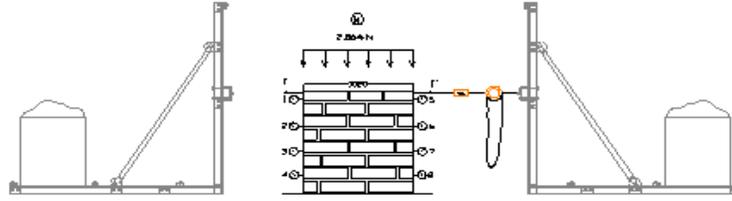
Esquema de ensaio da parede, no plano: pórticos de reacção, transdutores de deslocamento, dinamómetro e sistema de aplicação de forças horizontais na parede.
